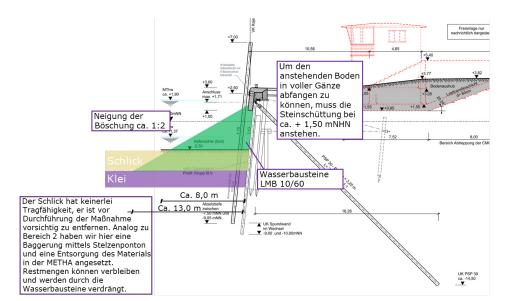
Variante 3: Neubau in alter Spundwandachse (Lageplan Bodenaustausch)
